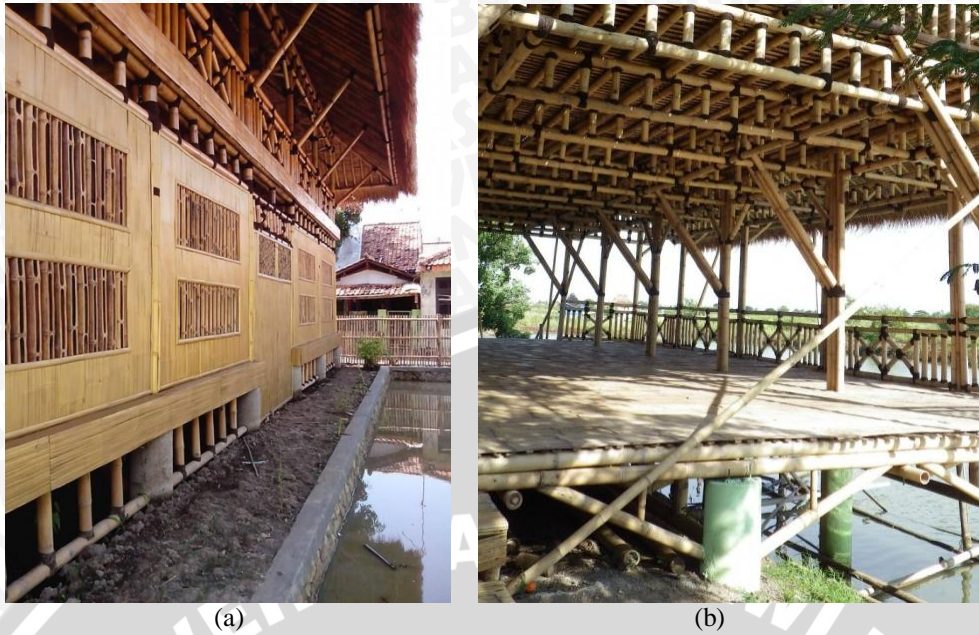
Bentuk dan struktur bangunan dengan modular
